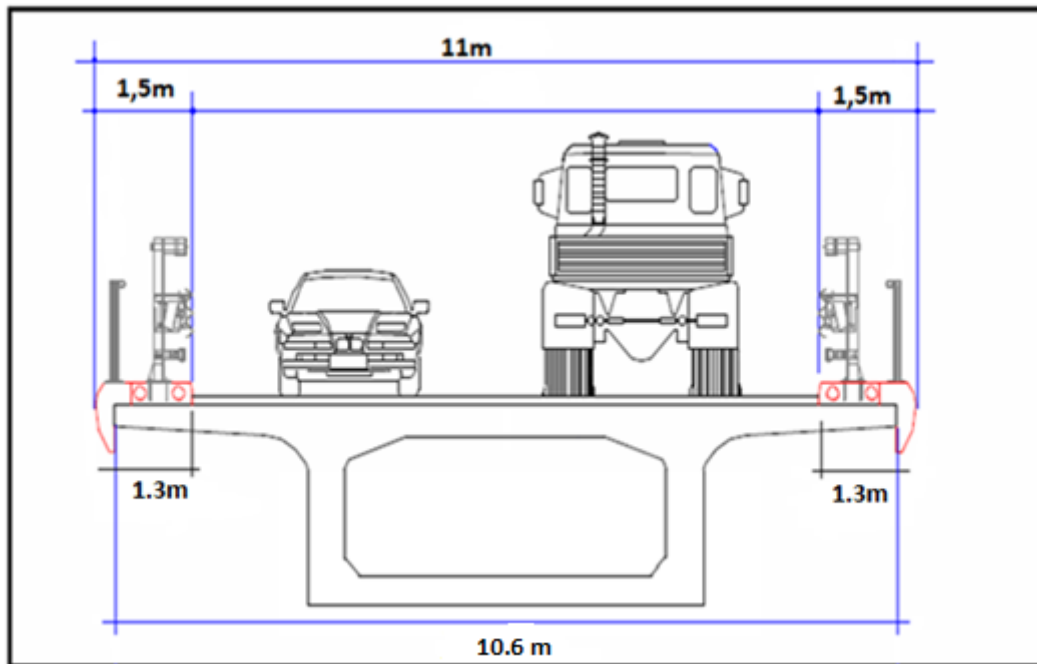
Coupe transversal d'une poutre caisson unique à âmes verticale
